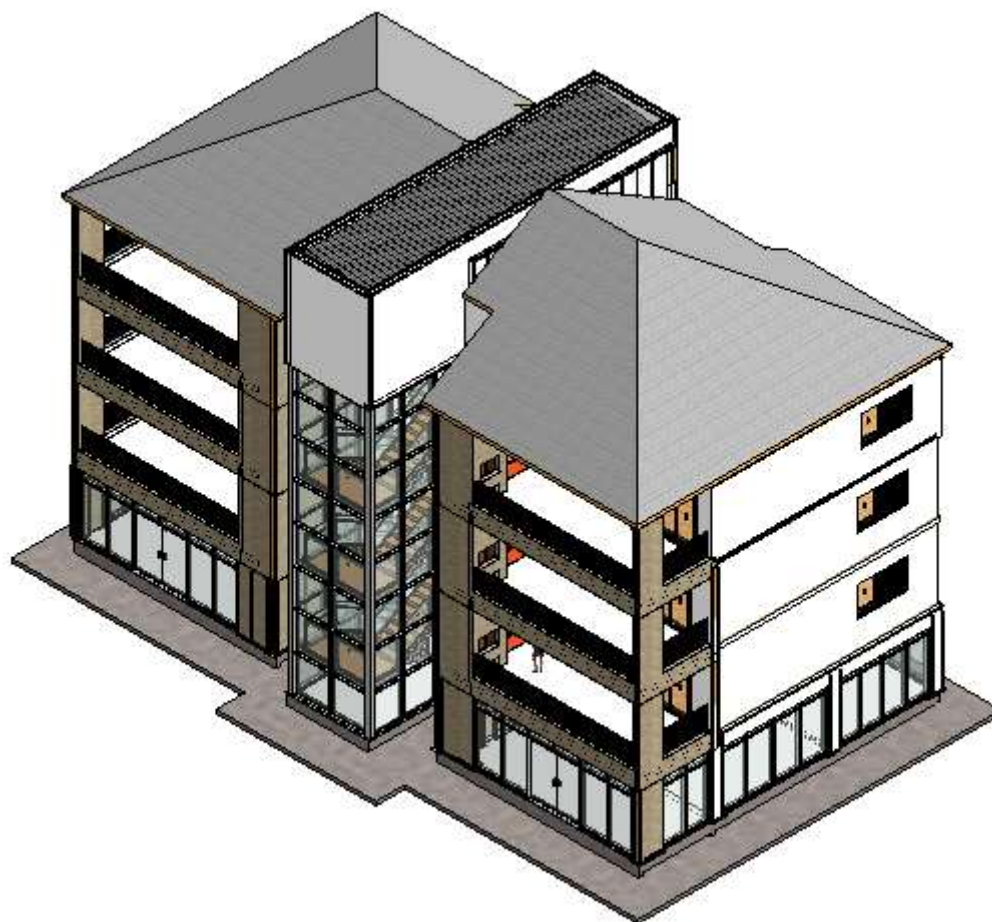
Estrutura de madeira em *wood frame* modelado em Revit
